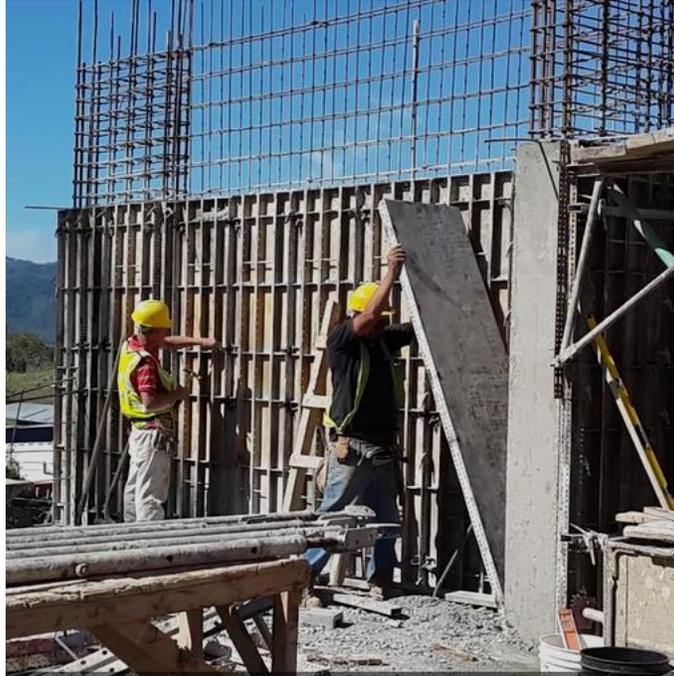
Desencofrado de columna y muro en el proyecto TIC'S
